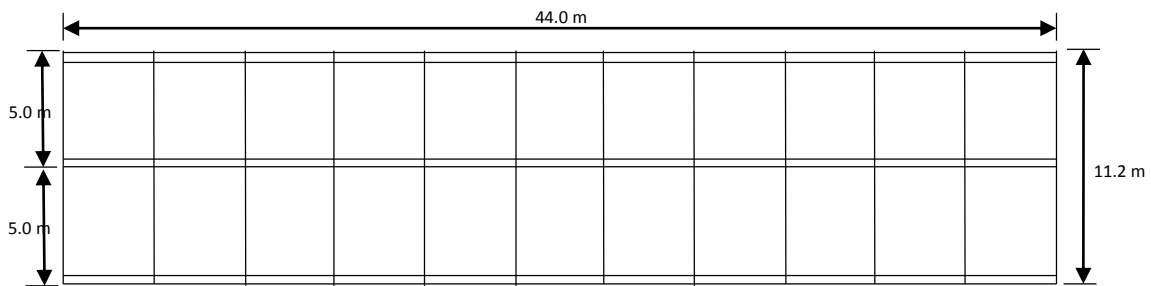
Vista de planta del invernadero. Datos en metros.
